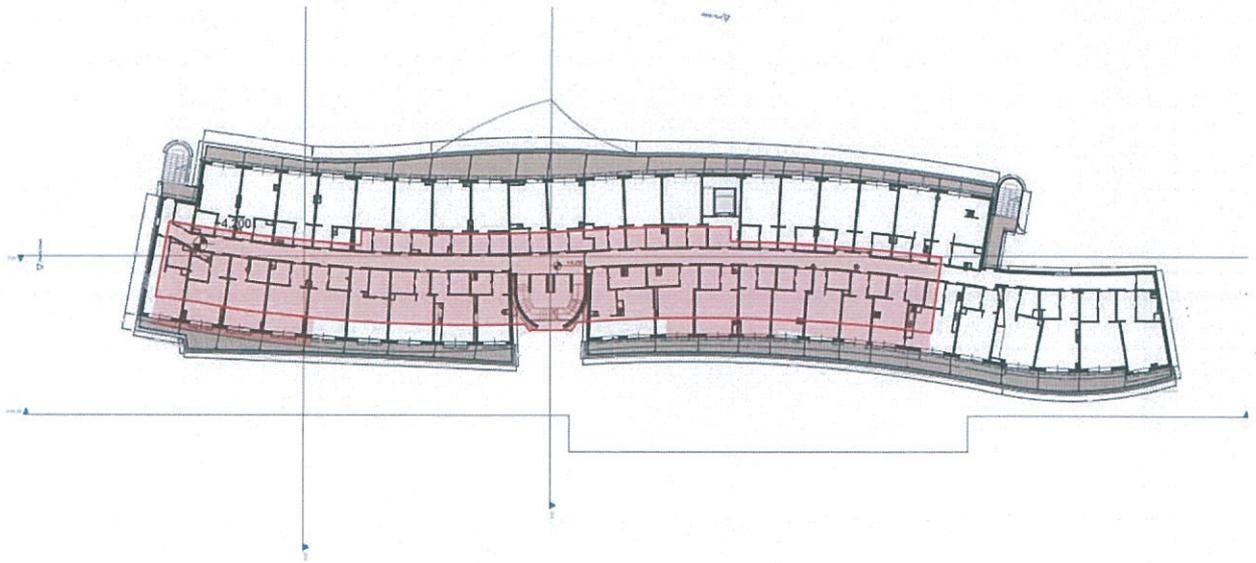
Planimetri e katit të parë (kuota +4.80)
